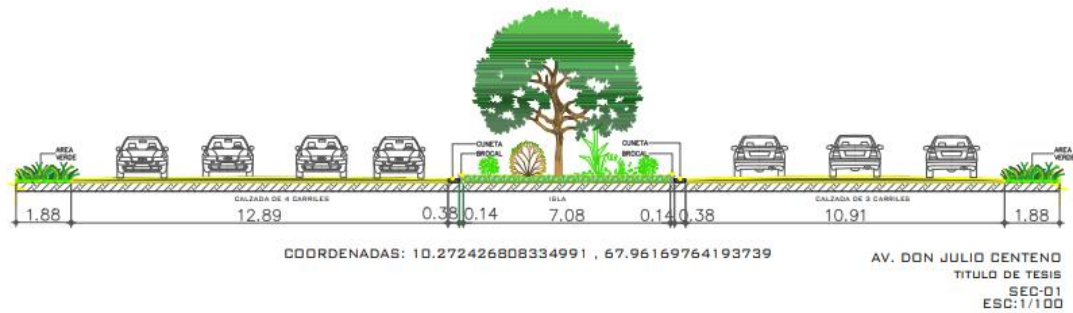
Tramo 1 de la Avenida Don Julio Centeno
